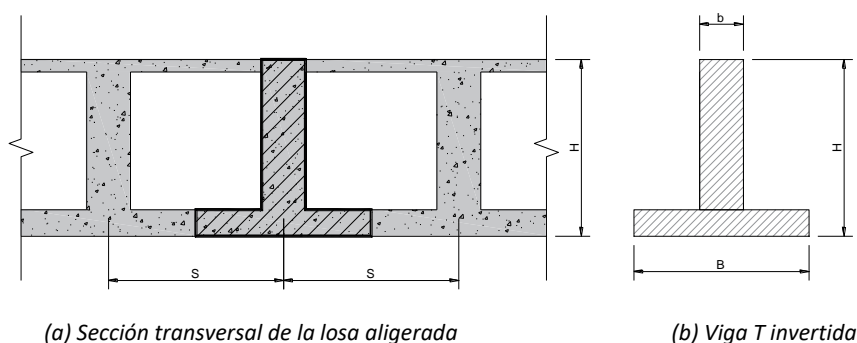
Sección transversal de la placa aligerada de cimentación (sistema viga T invertida)
